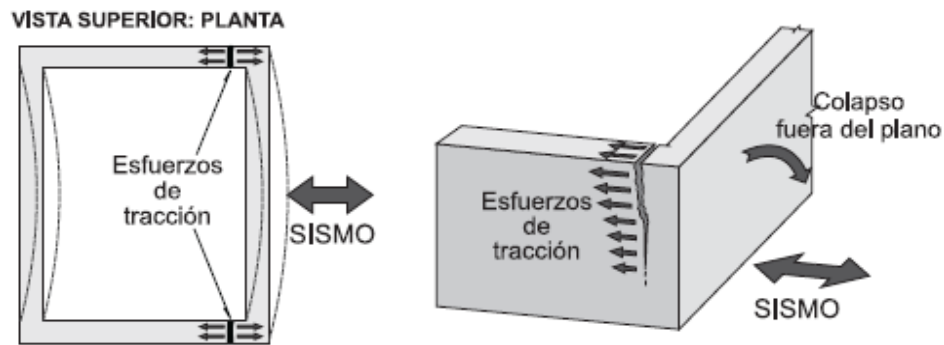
Grietas verticales en esquina (Fuente: PNUD, 2008)
